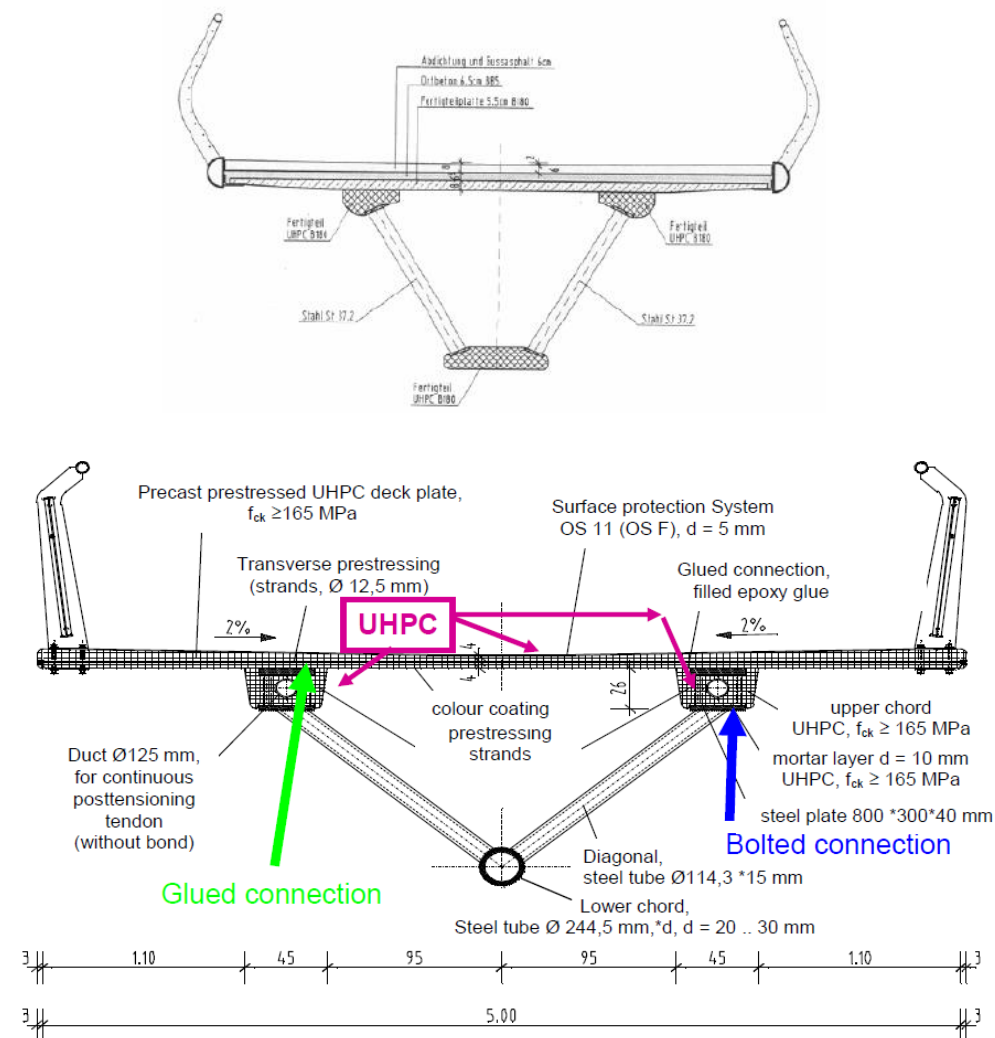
Sección transversal propuesta inicialmente y sección transversal final [Fehling 2009]
